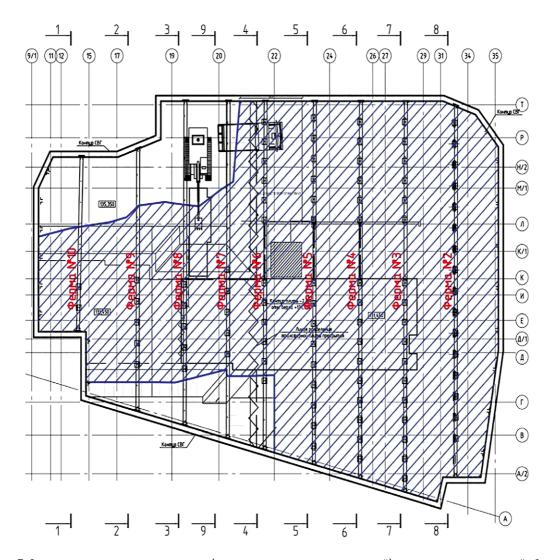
Схема участков с удаленным грунтом (зона выемки выделена штриховкой) под перекрытием, верхний обрез которого расположен на отм. +135.650 на 7-м цикле измерений
